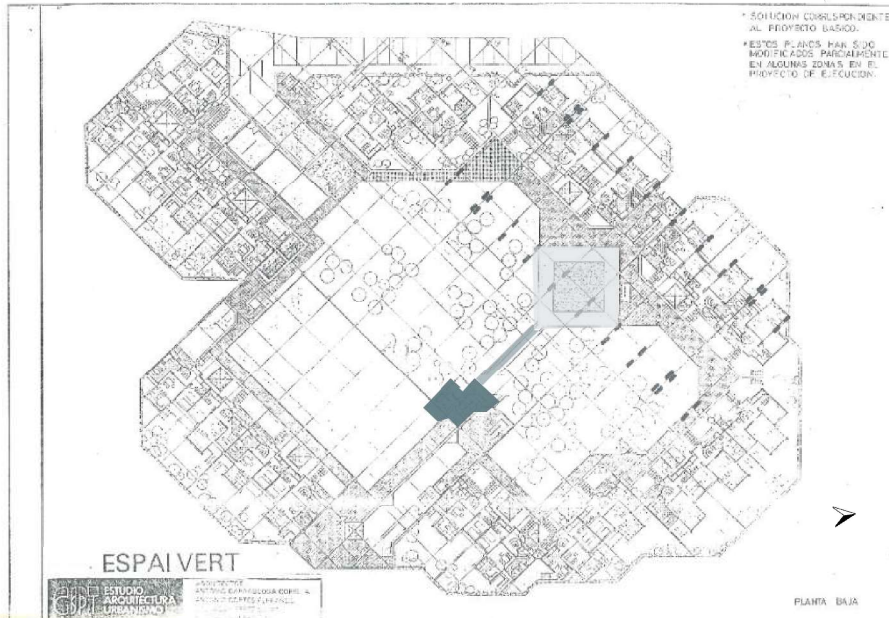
Diagrama de los elementos acuáticos sobre la Planta baja proyecto básico Espai Verd.
